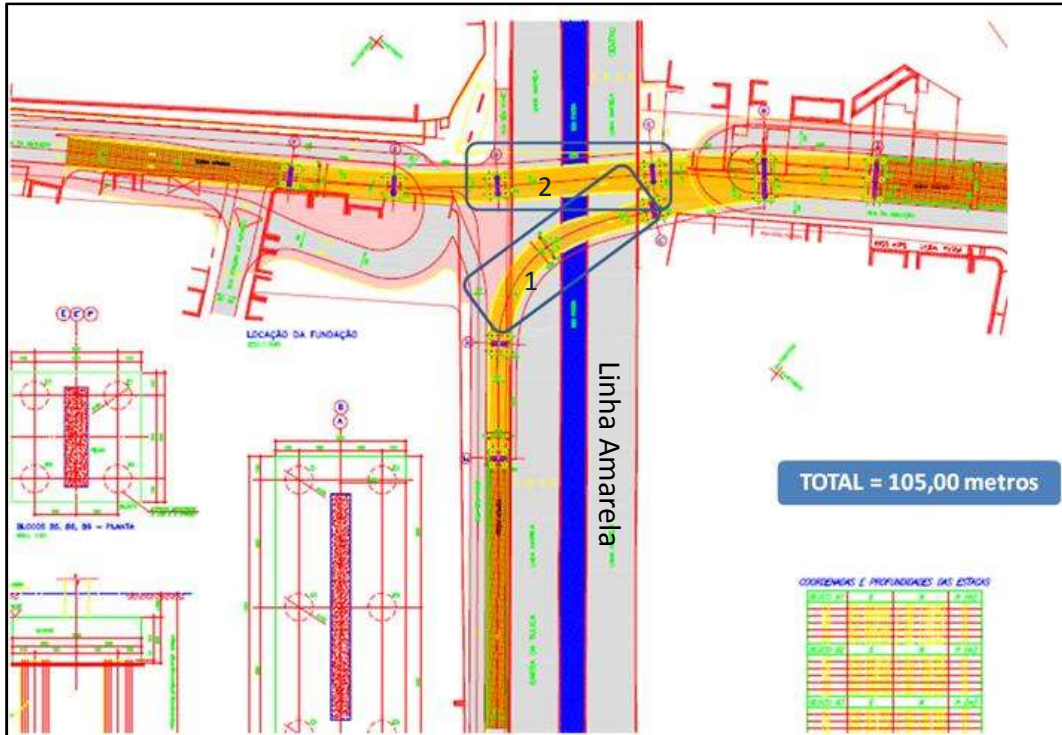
Trechos onde serão executadas vigas caixão em balanço sucessivo com aduelas moldadas no local
